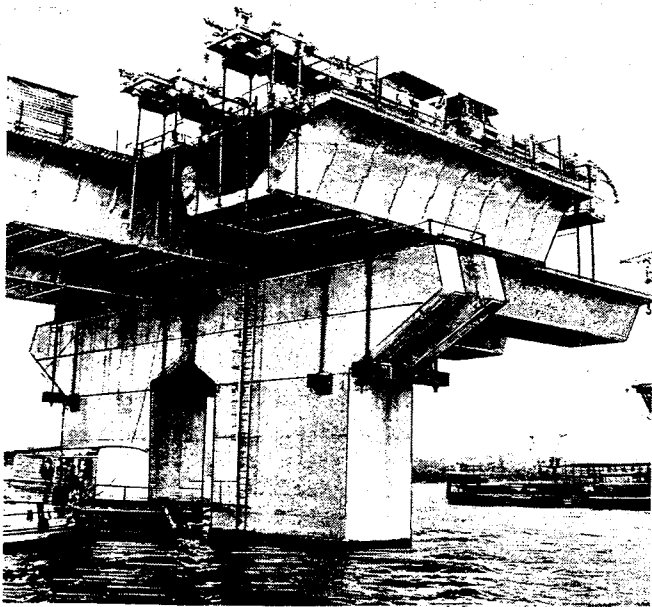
Монтаж железобетонного пролетного строения из блоков К
